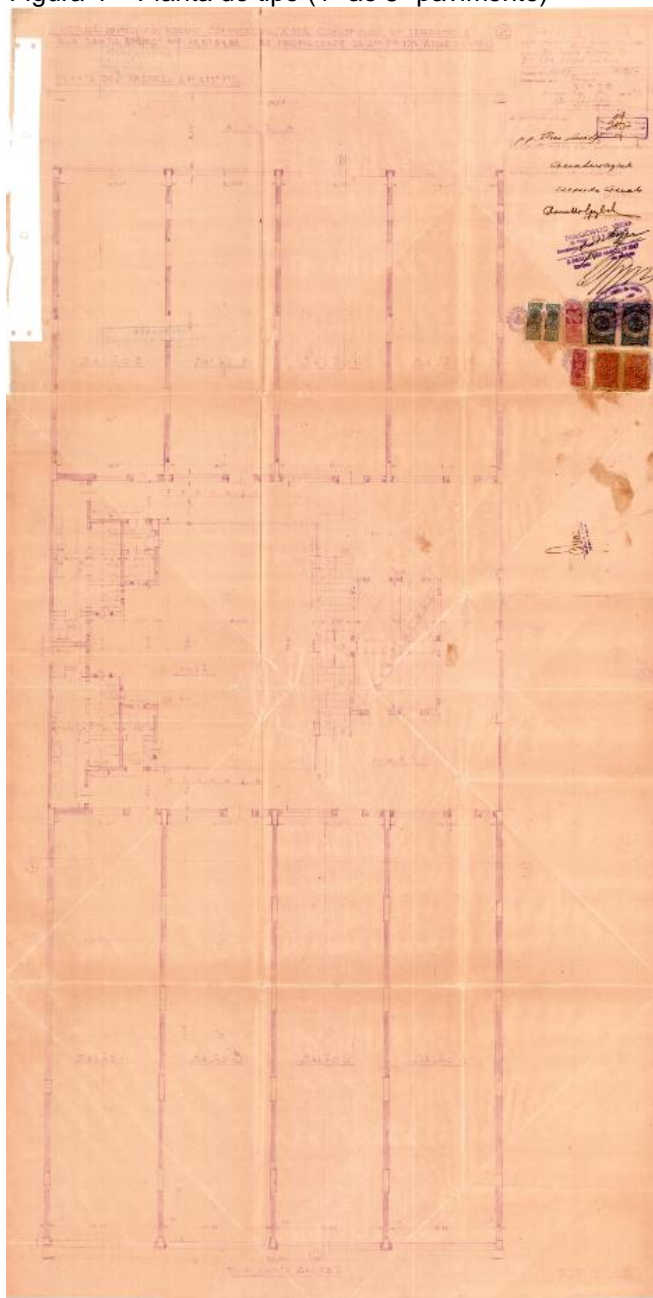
Planta do tipo (1º ao 8º pavimento)
